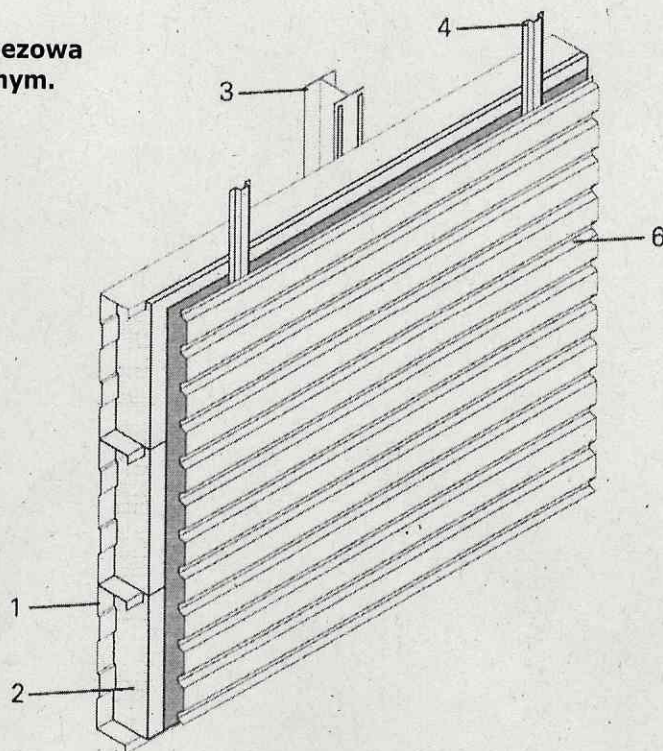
Schemat budowy ściany - ściany z elewacją ze paneli elewacyjnych
